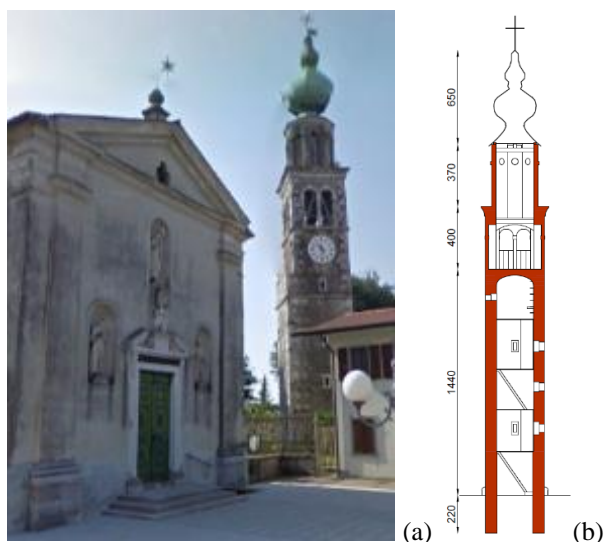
Il campanile: (a) vista e (b) sezione verticale.
